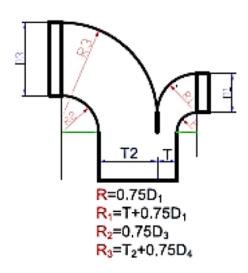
المسقط الأفقى مع مقطع أمامي لمجرى هواء بخطين مع مأخذ هواء مثالي ضمن بناية
